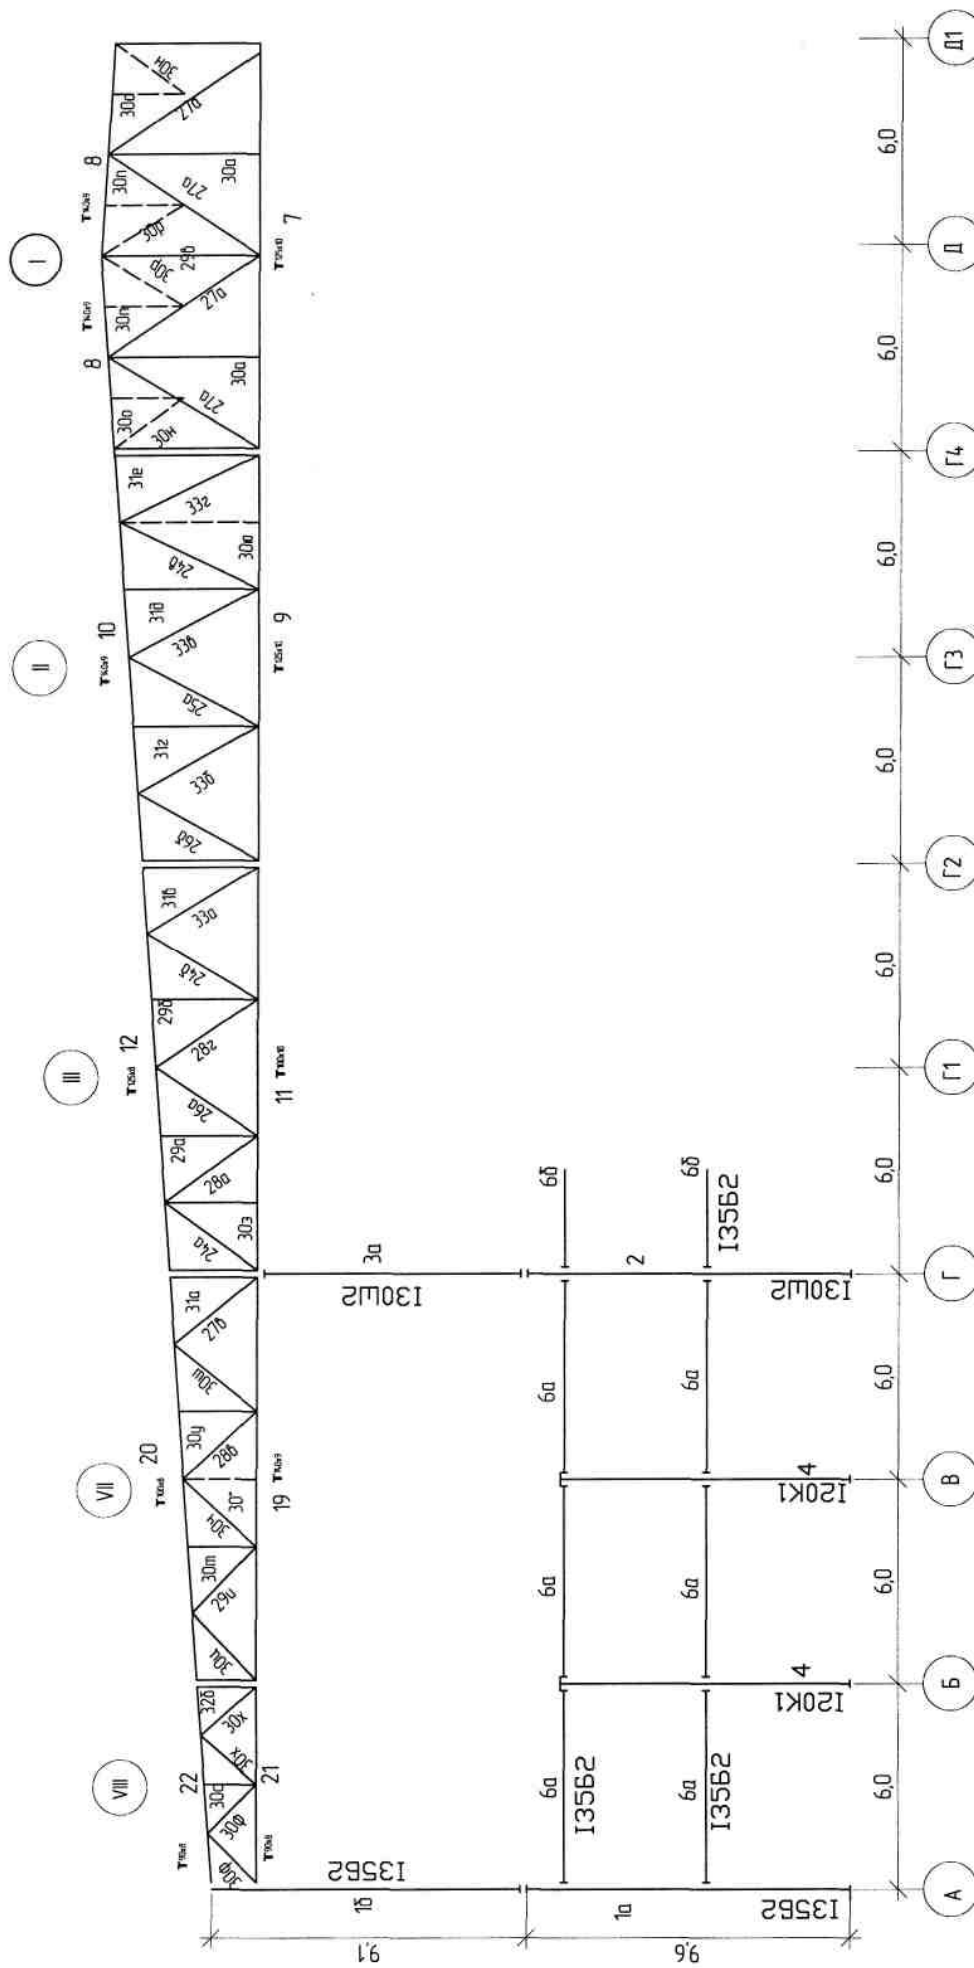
Монтажная схема элементов поперечной рамы каркаса – левая половина
